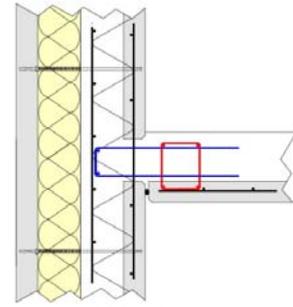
Plancher suspendu avec attentes posées sur chantier
